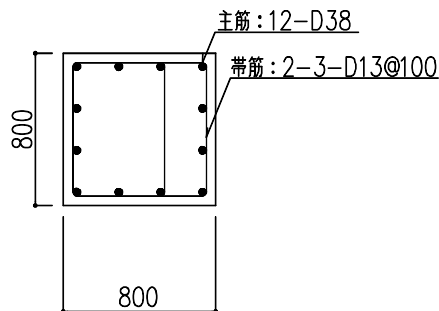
柱の配筋図 (地下2階, X4/YP 通り, 柱頭部) (単位:mm)
